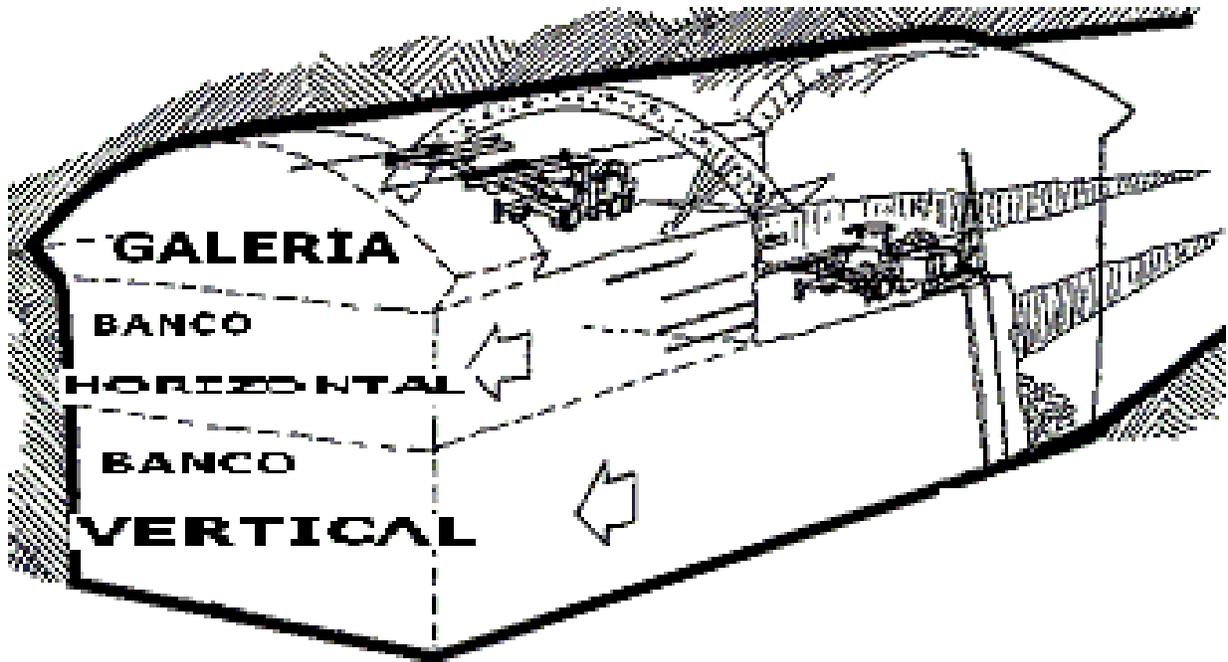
Galería piloto con banco horizontal y vertical⁽¹⁵⁾
